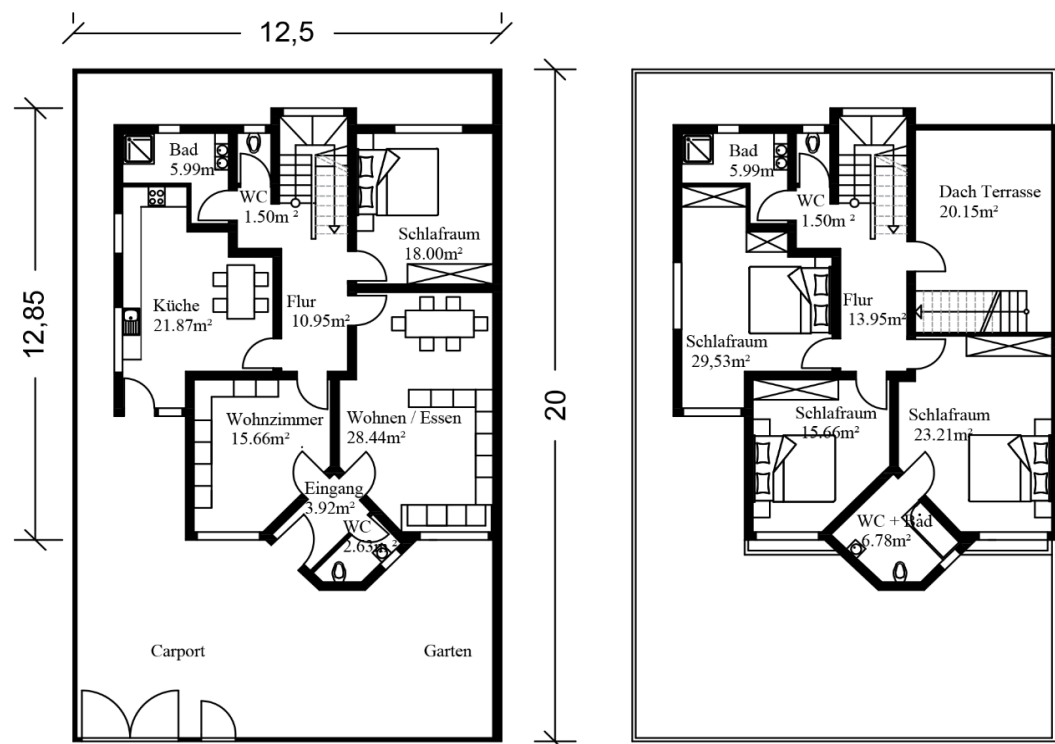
Villa Grundriss Typ B, 250 m²¹⁸⁹
